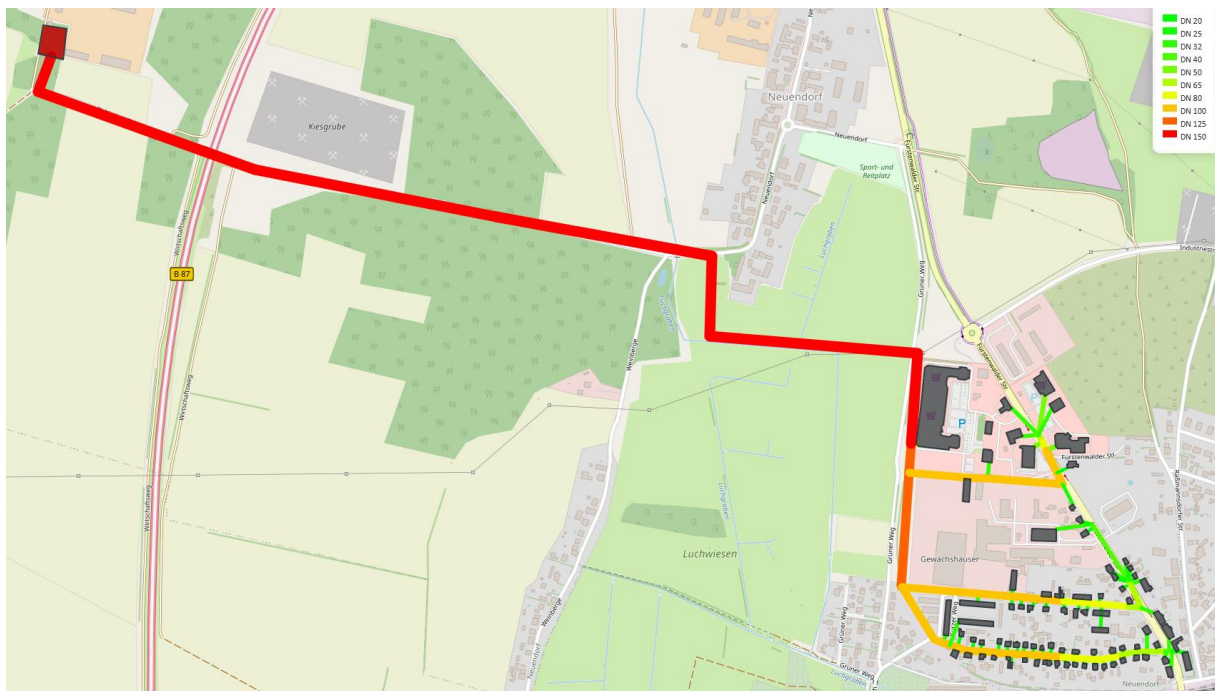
Entwurf Trassenplan Wärmenetz Fürstenwalder Straße
